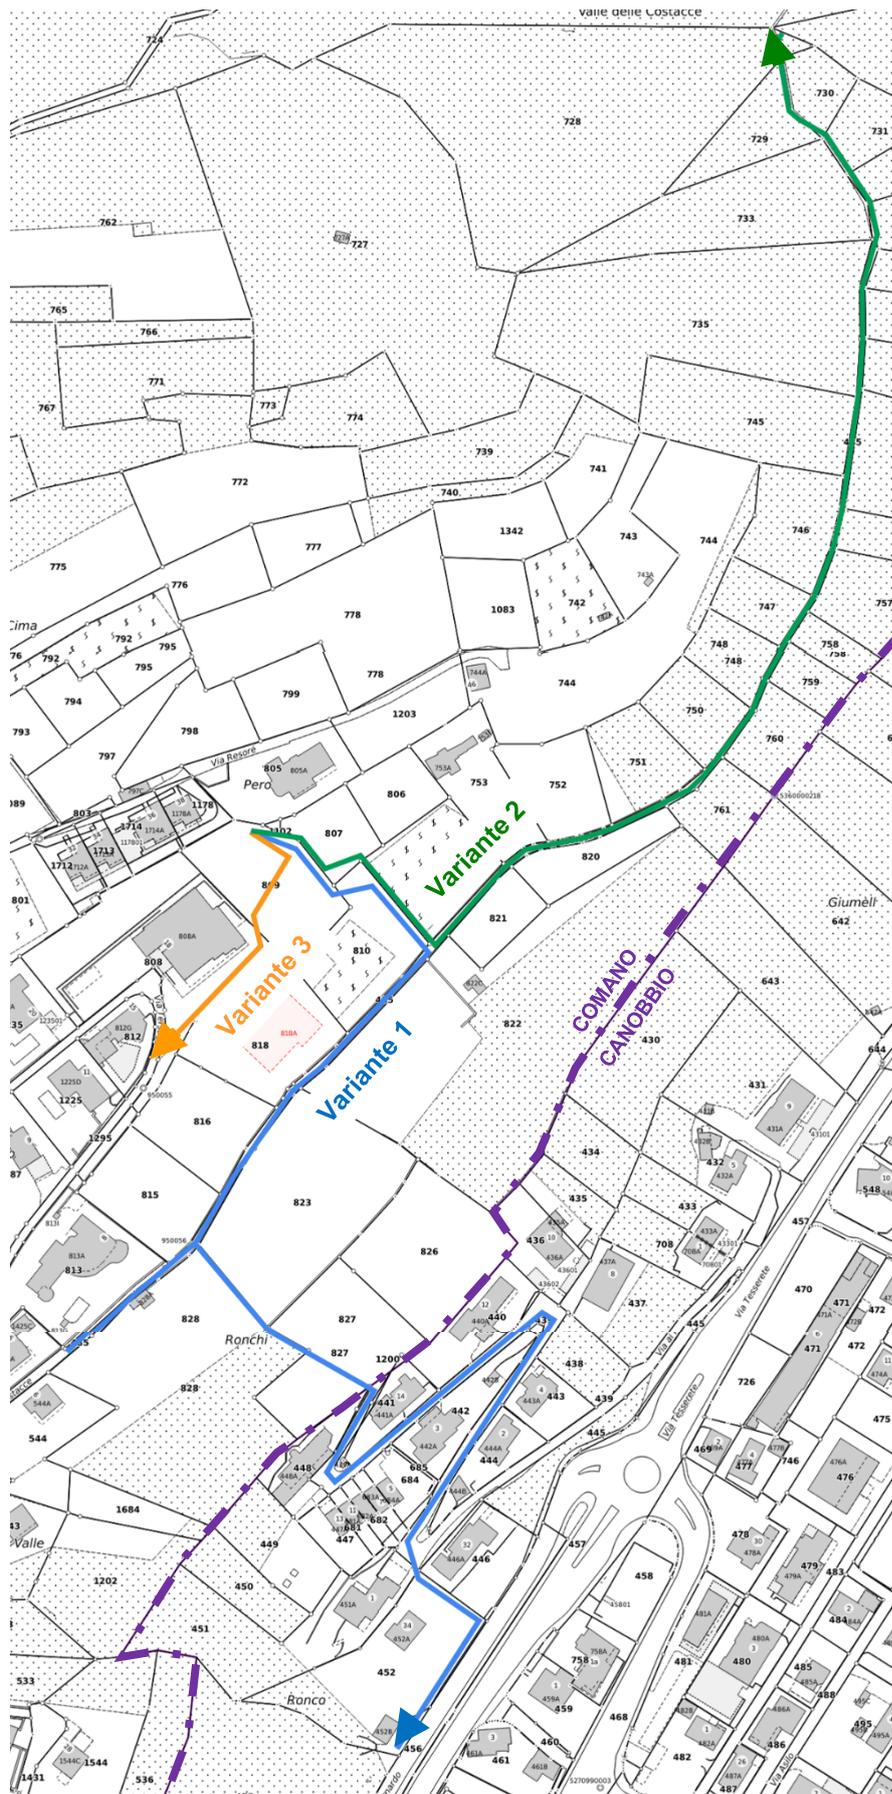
Zona Costacce: Variante 1, Variante 2, Variante 3
